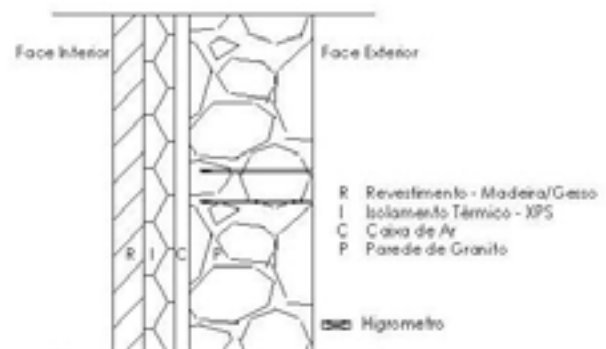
Corte da parede com localização esquemática dos higrómetros
